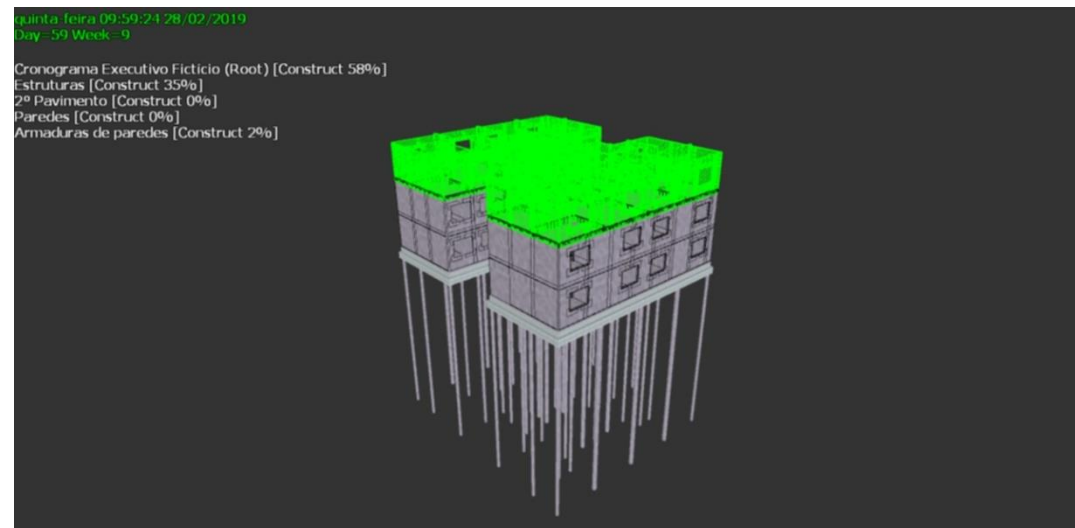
Telas de paredes do 2º pavimento sendo armadas (verde).
